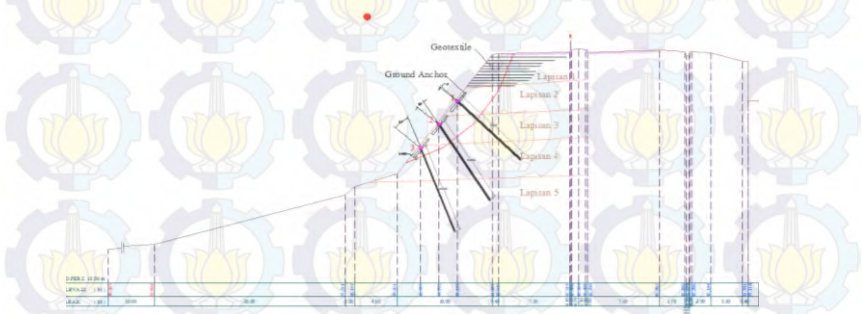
Letak pemasangan ground anchor dan geotextile pada STA. 9+110
